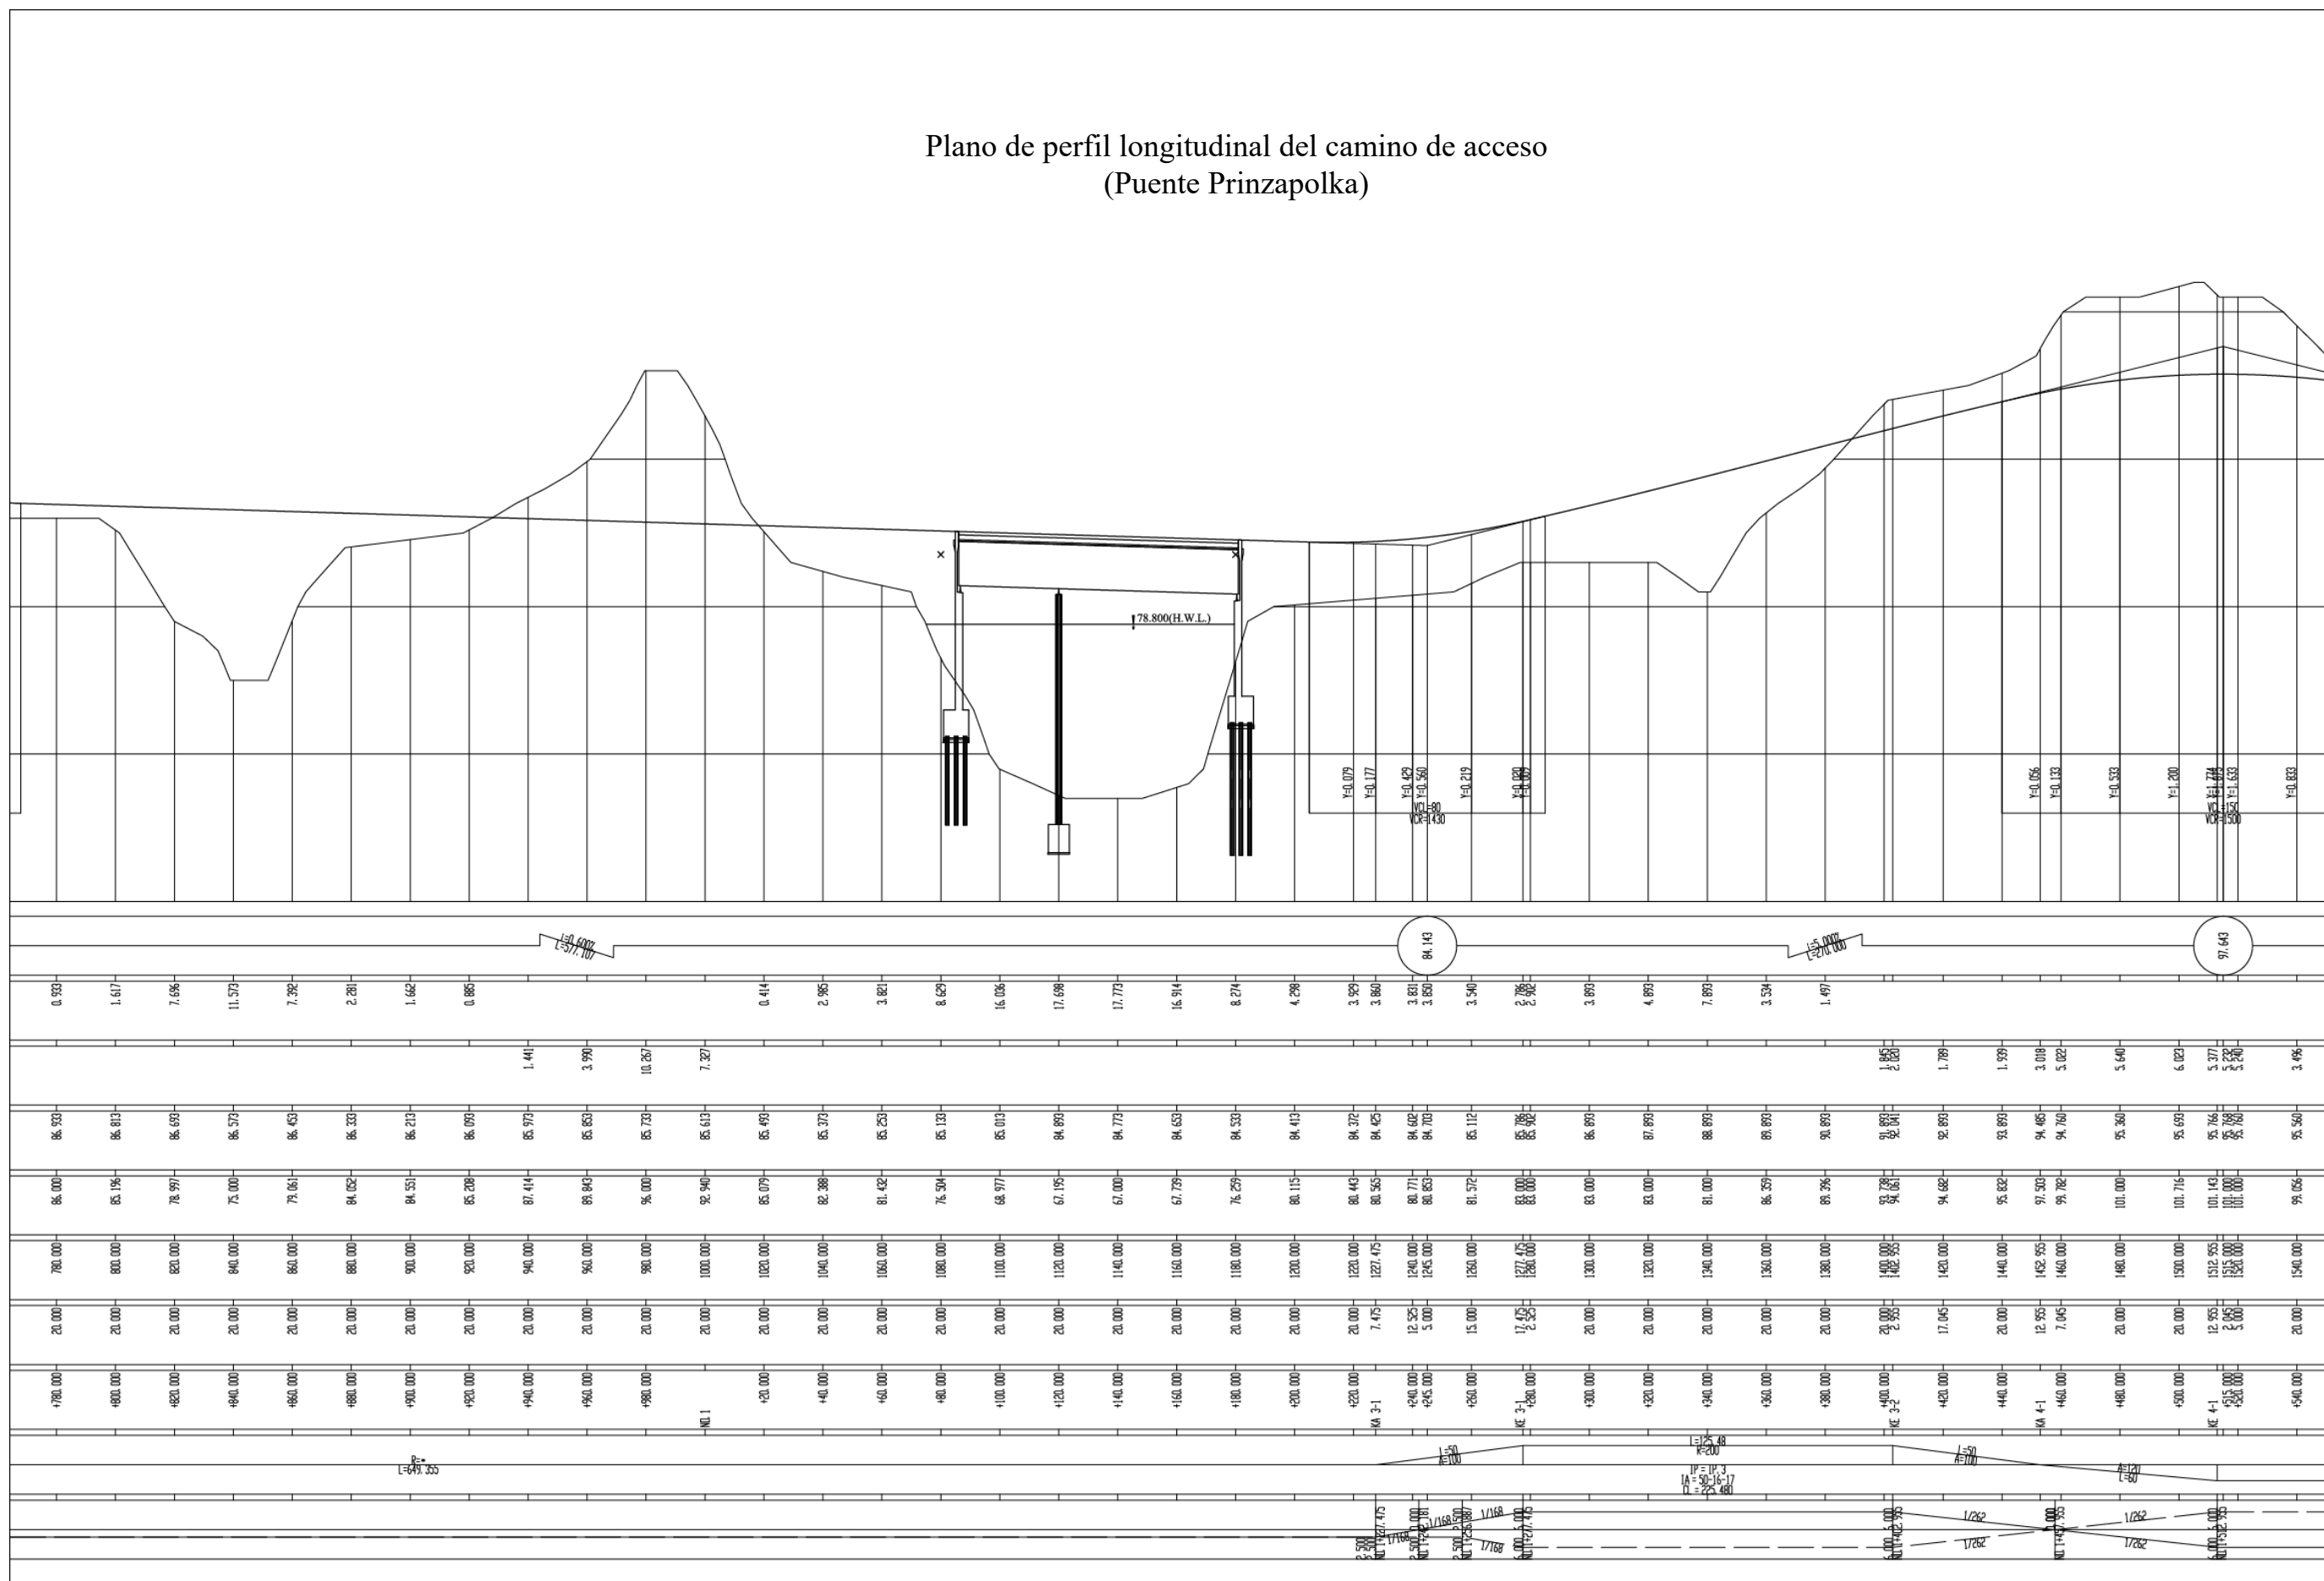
Plano de perfil longitudinal del camino de acceso (Puente Prinzapolka)
